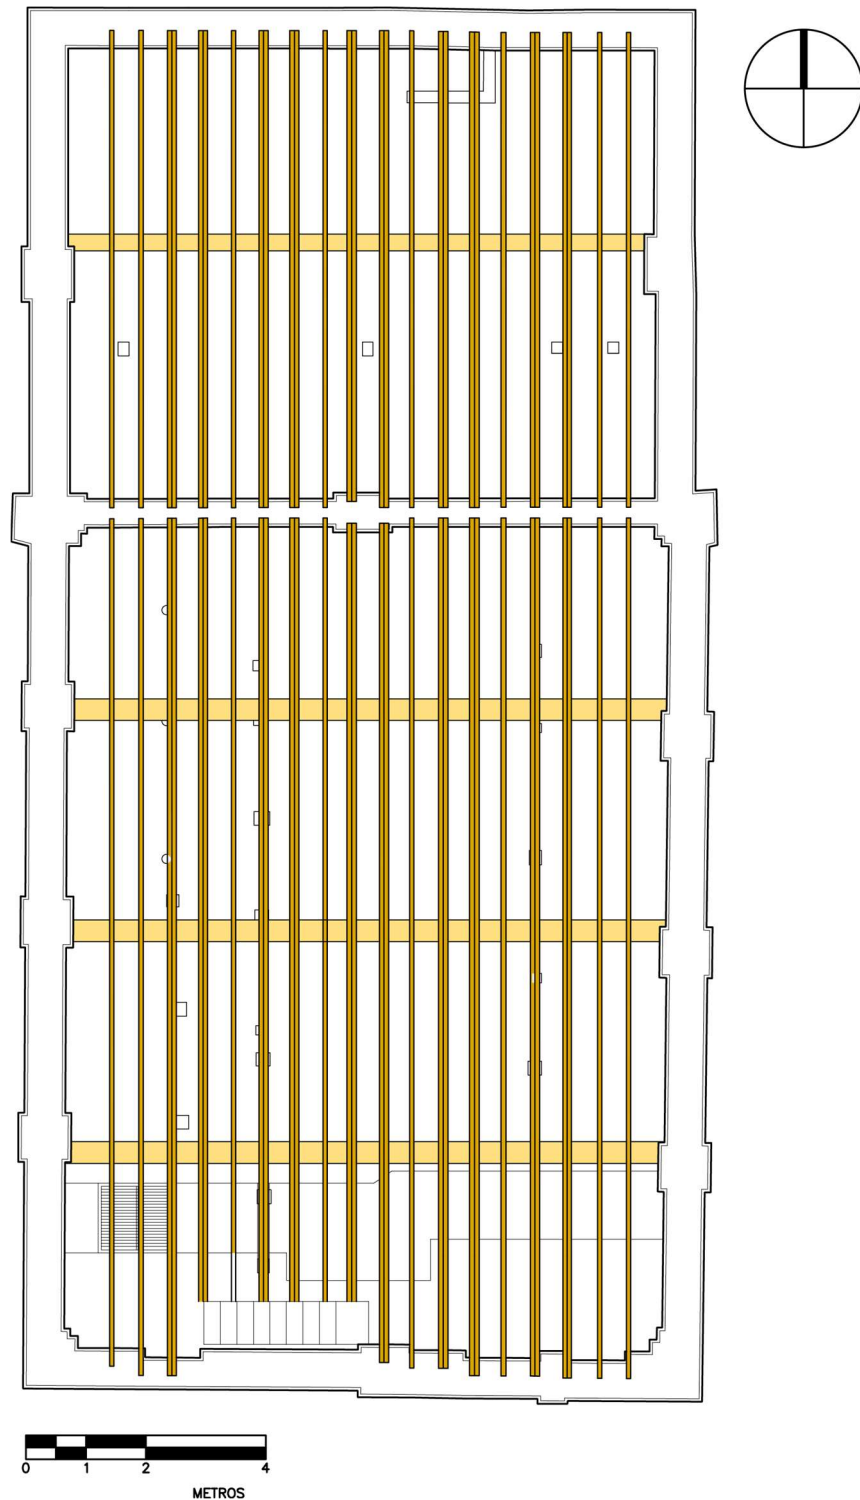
Levantamiento del estado actual. Viguería en planta baja. Dado que es el nivel que recibe el mayor peso, en alguna de sus intervenciones recibió refuerzos de vigas de madera colocándolas cada dos vigas, la distribución de las vigas principales sigue el ritmo de las columnas de los muros de tabique. Elaboración por M.A.R.C.
